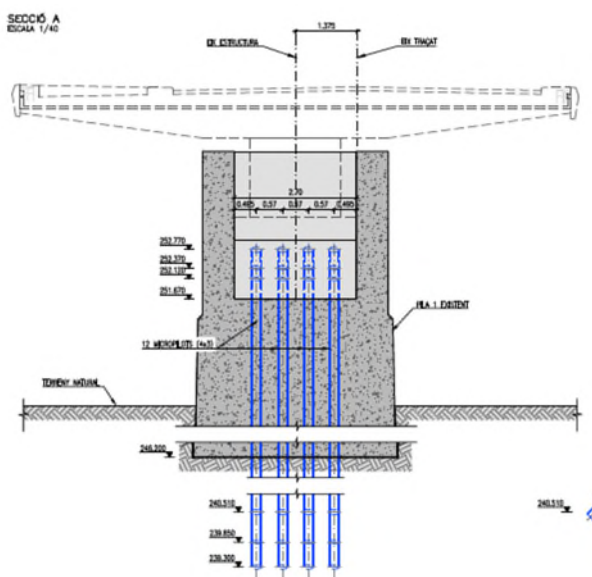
Detalle de sección transversal del tablero sobre pilas.
